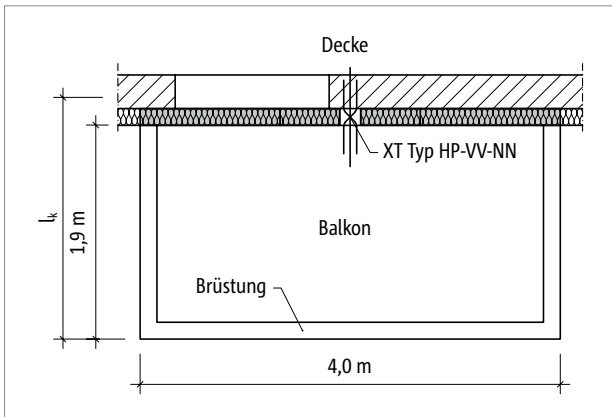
Schöck Isokorb® XT Typ KL, HP: Grundriss
